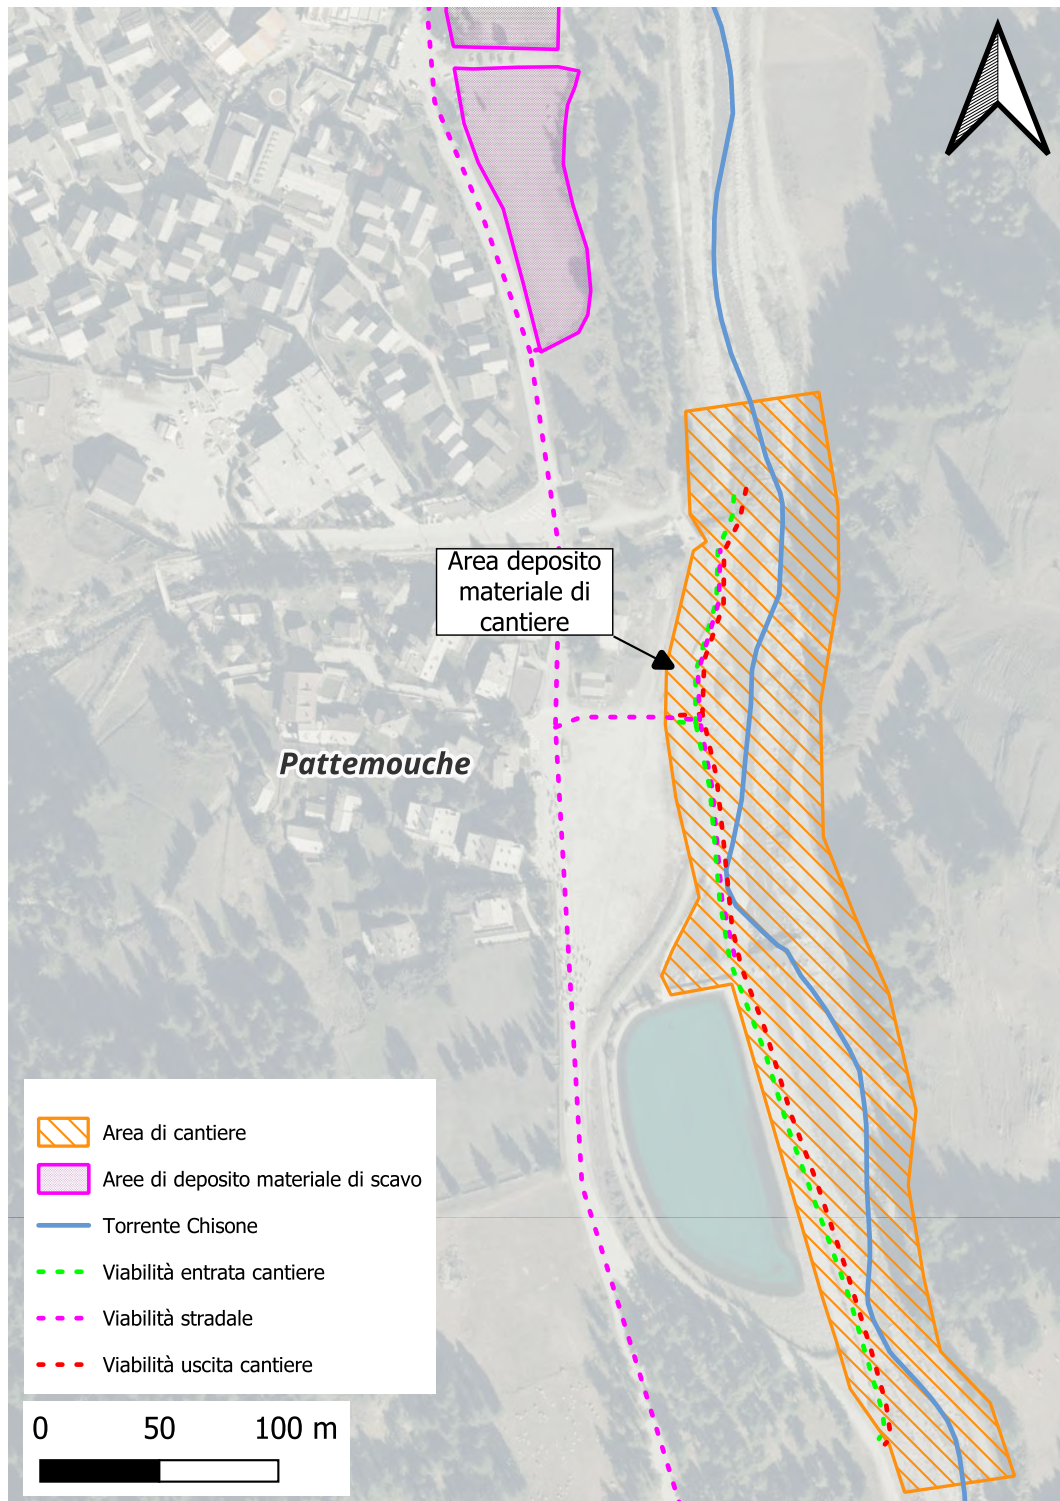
Viabilità di accesso al cantiere, lato valle
